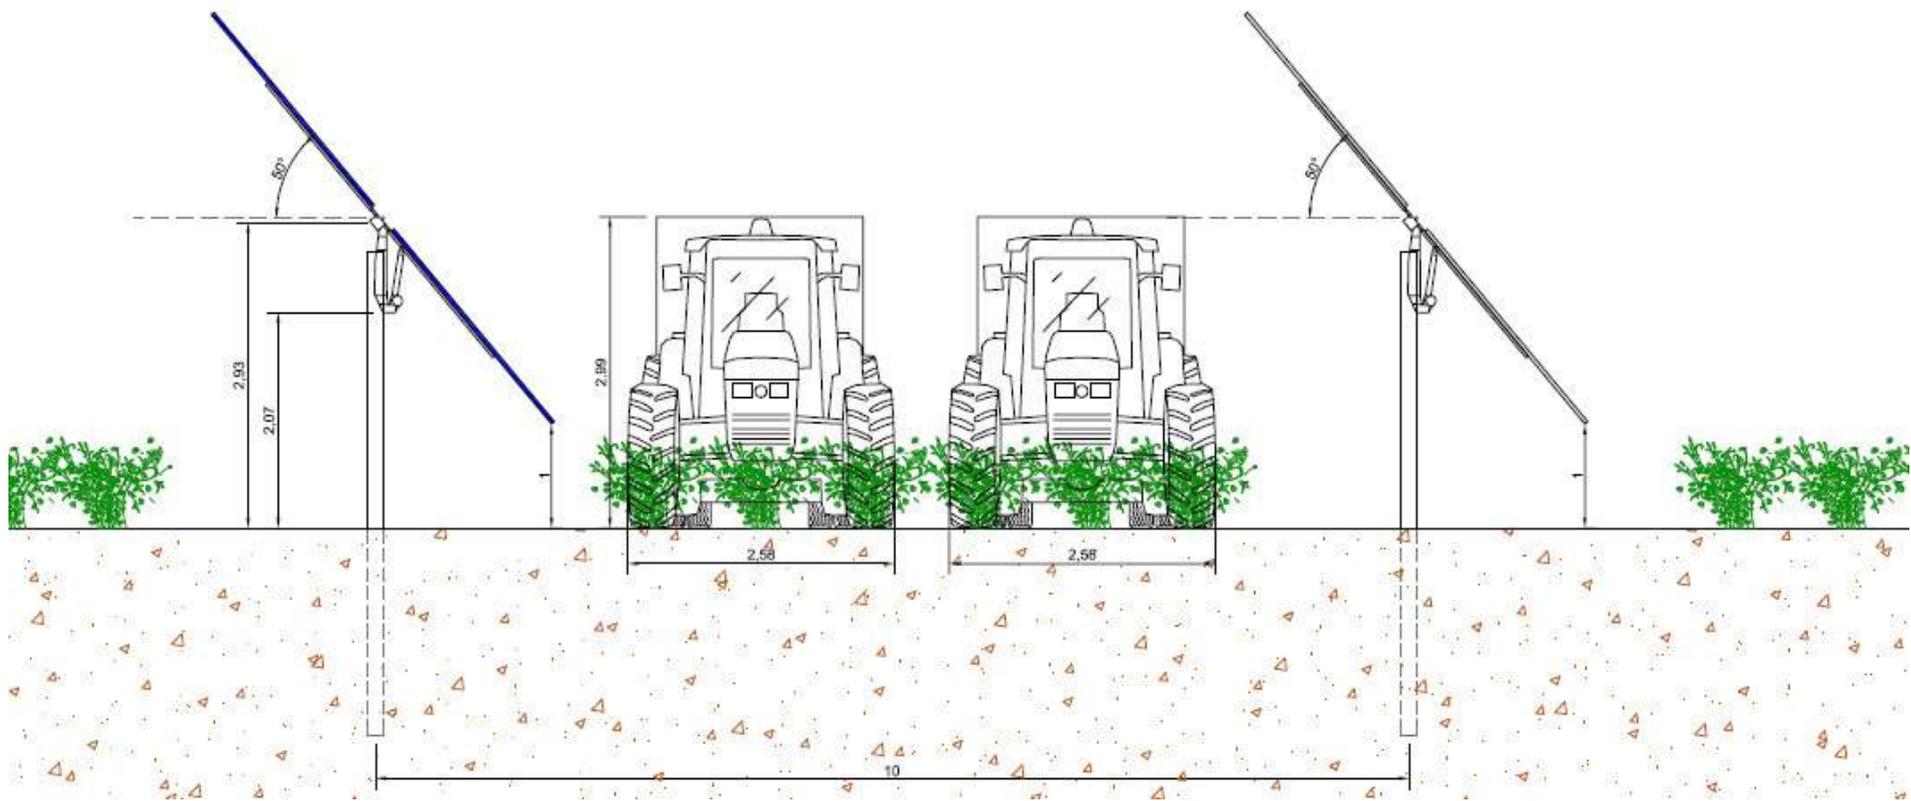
Schema di impianto in sezione trasversale con trackers in posizione inclinata
